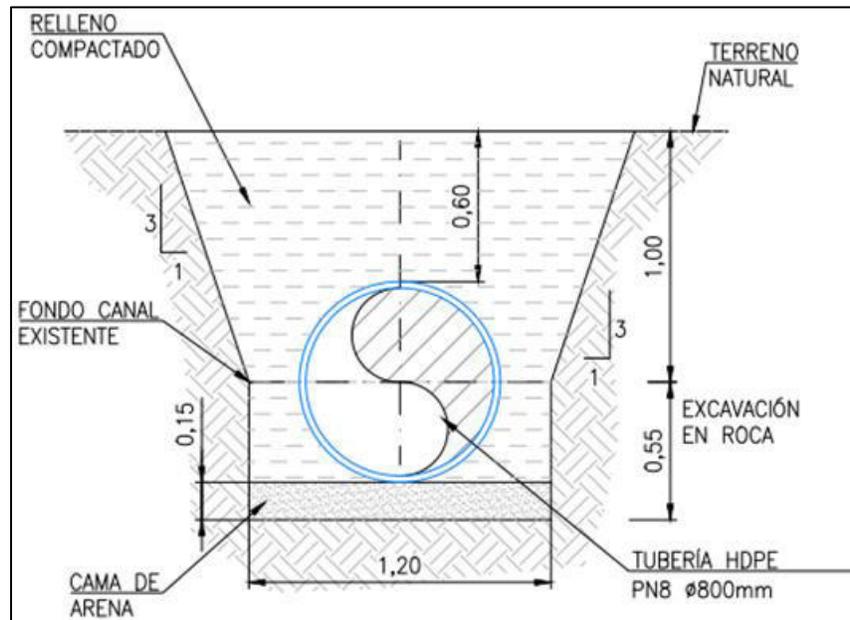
Disposición general Tubería de Conducción y Obras anexas
